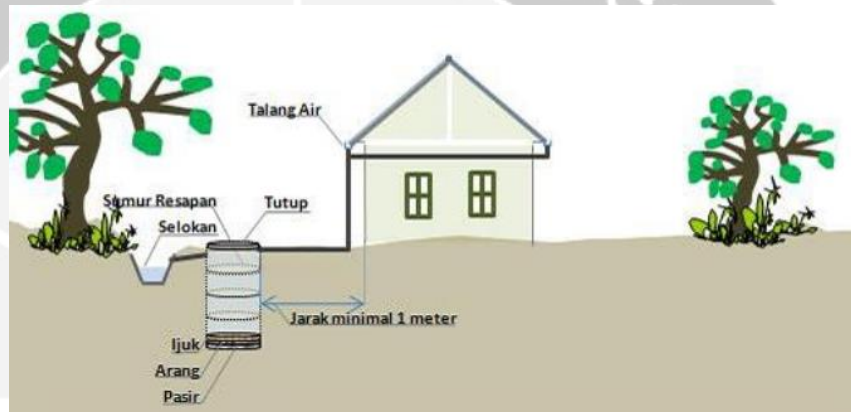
Konsep Struktur dan Konstruksi Bangunan
